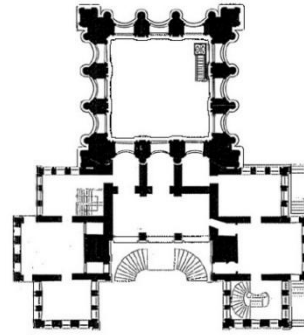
1857 Selimeye Kışlası planı (Url :7)
